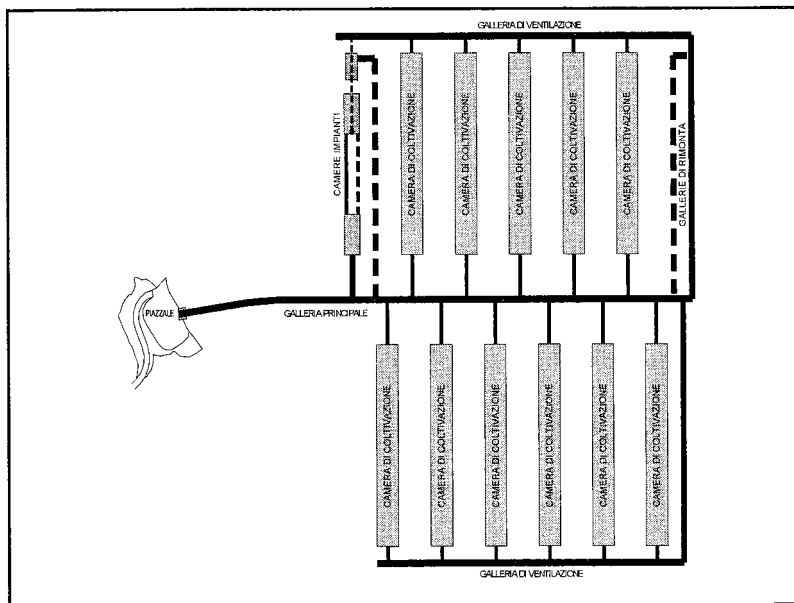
Schema planimetrico delle camere di coltivazione e delle gallerie di servizio.
